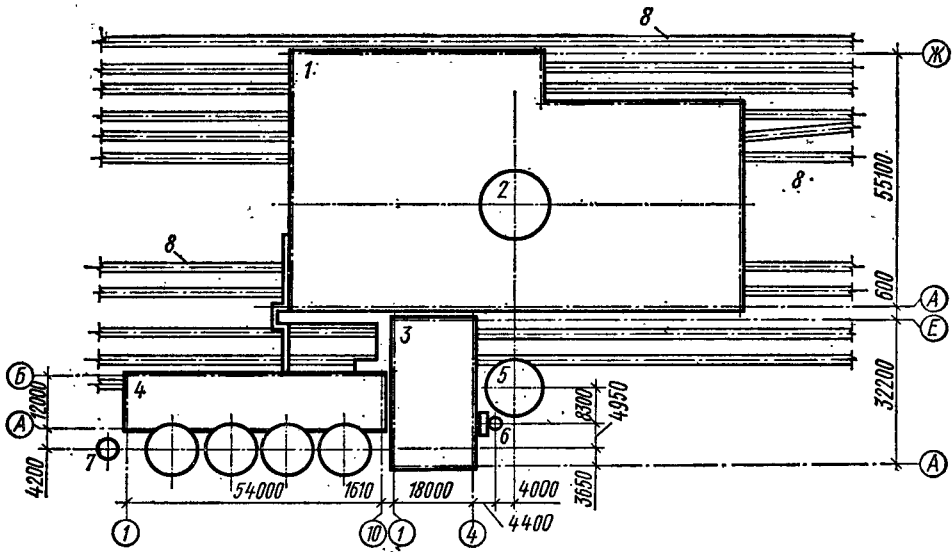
Схема планировочного прямоугольного решения литейного двора:
